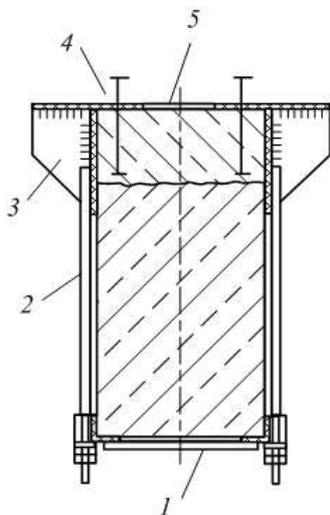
Усиление стальной обоймой сжатой зоны подкрановой балки: 1 – пластина; 2 – стяжные болты; 3 – несъемная опалубка сжатой зоны; 4 – установочные болты; 5 – отверстие для подачи бетона
